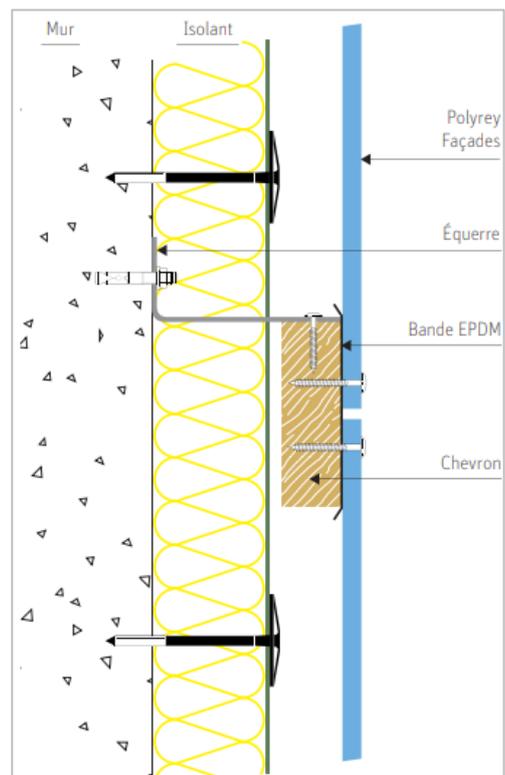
Coupe de fixation d'un panneau HPL
